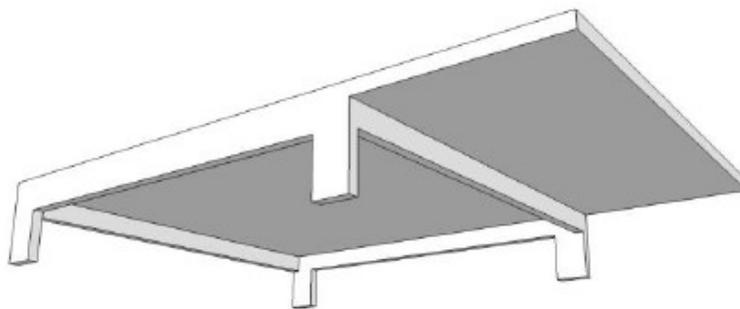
Modelo 02 com Laje em Balanço (Edificação Térrea)
